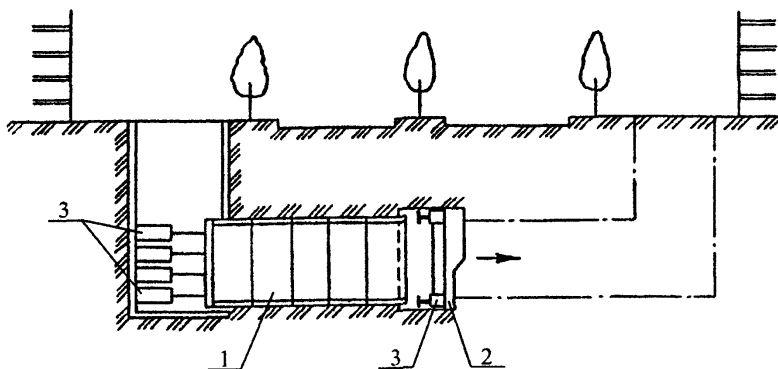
Схема производства работ при строительстве подземных сооружений способом продавливания объемных железобетонных элементов
